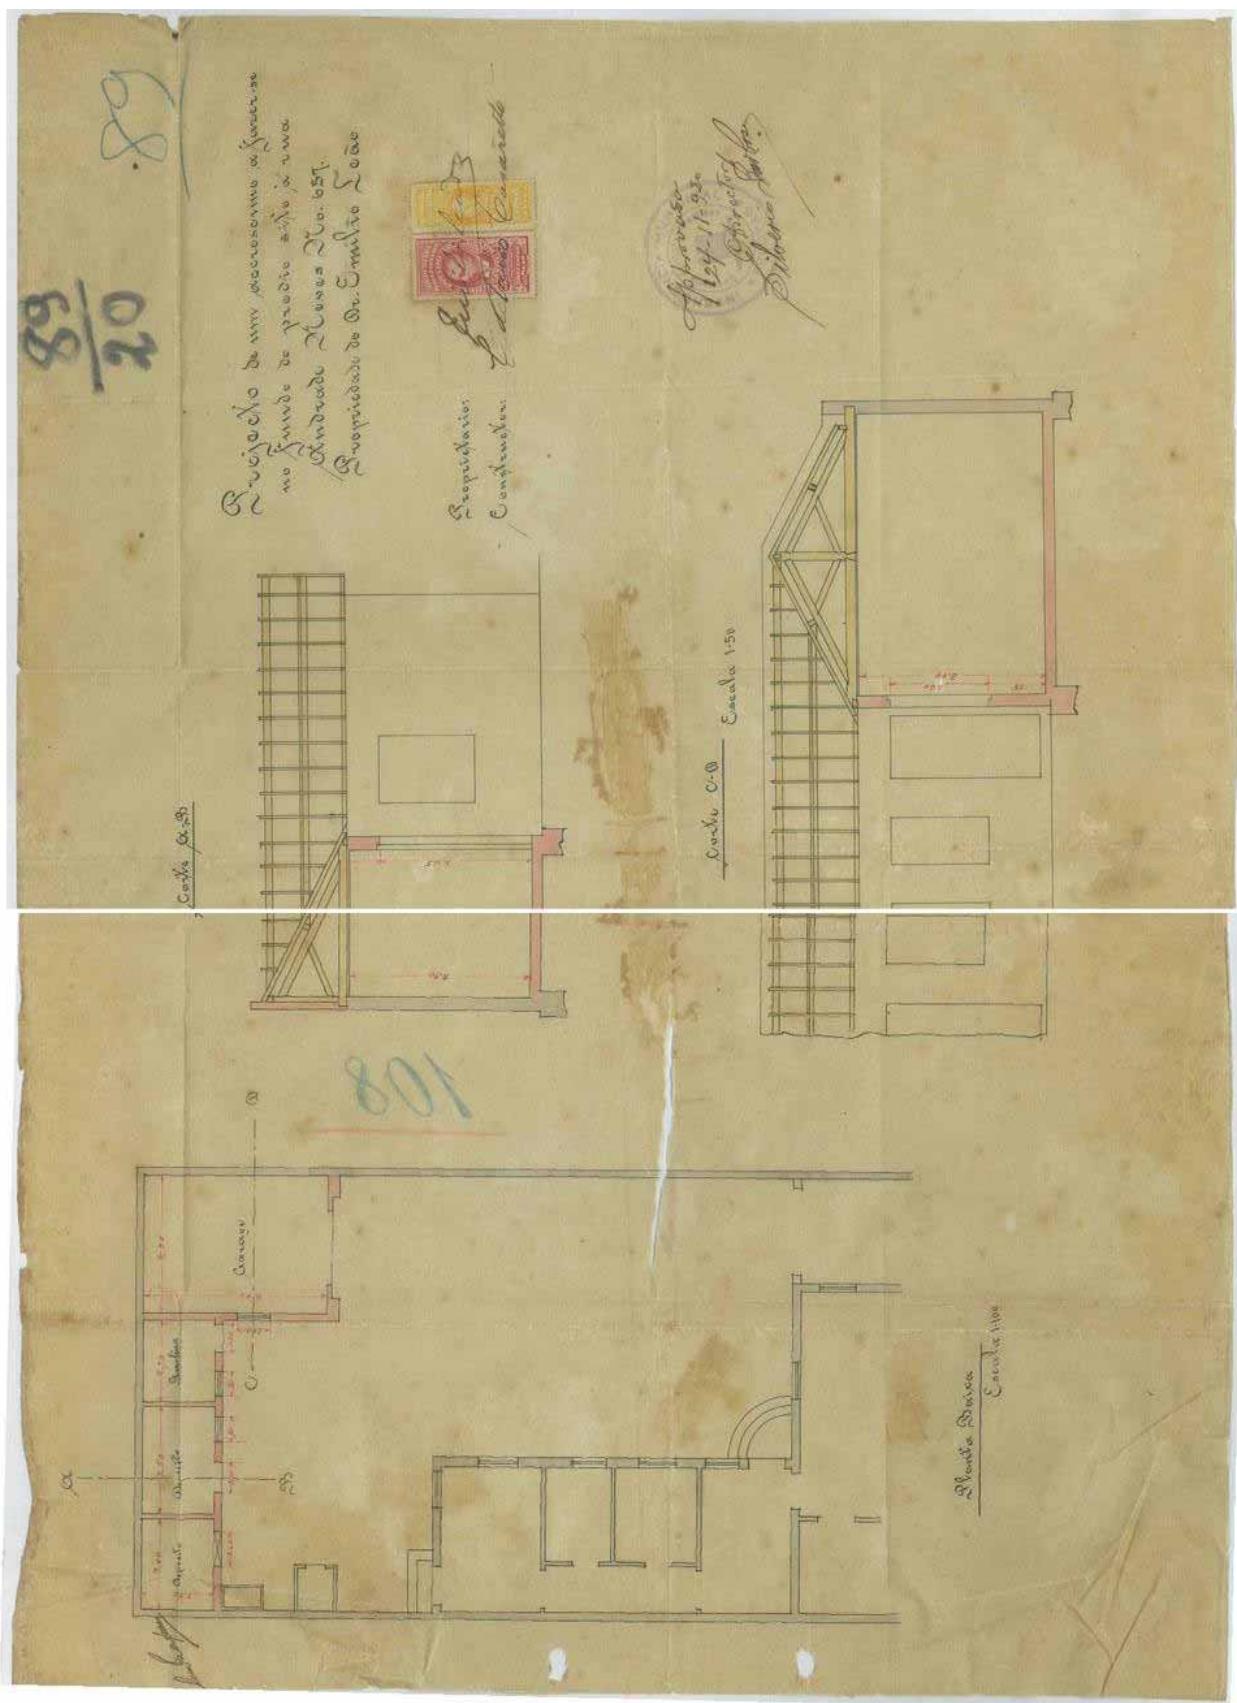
Planta de anexo ao prédio da Rua Andrade Neves, 657
